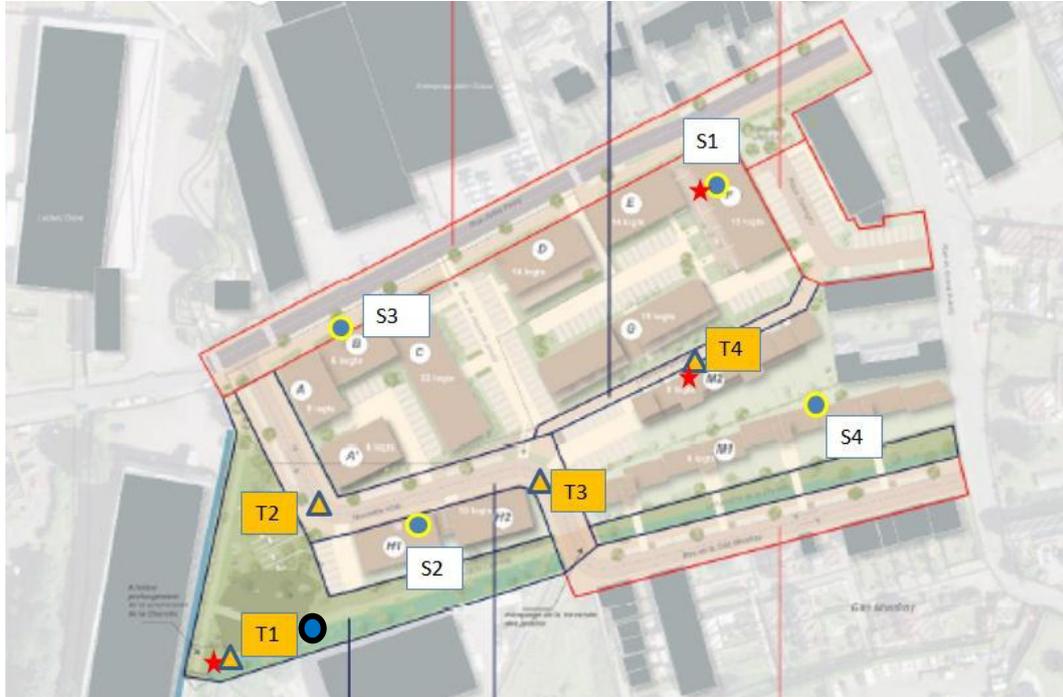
Plan masse du projet d'aménagement de la ZAC Clairette et localisation des sondages (Source : Ville de Déville-Lès-Rouen)
